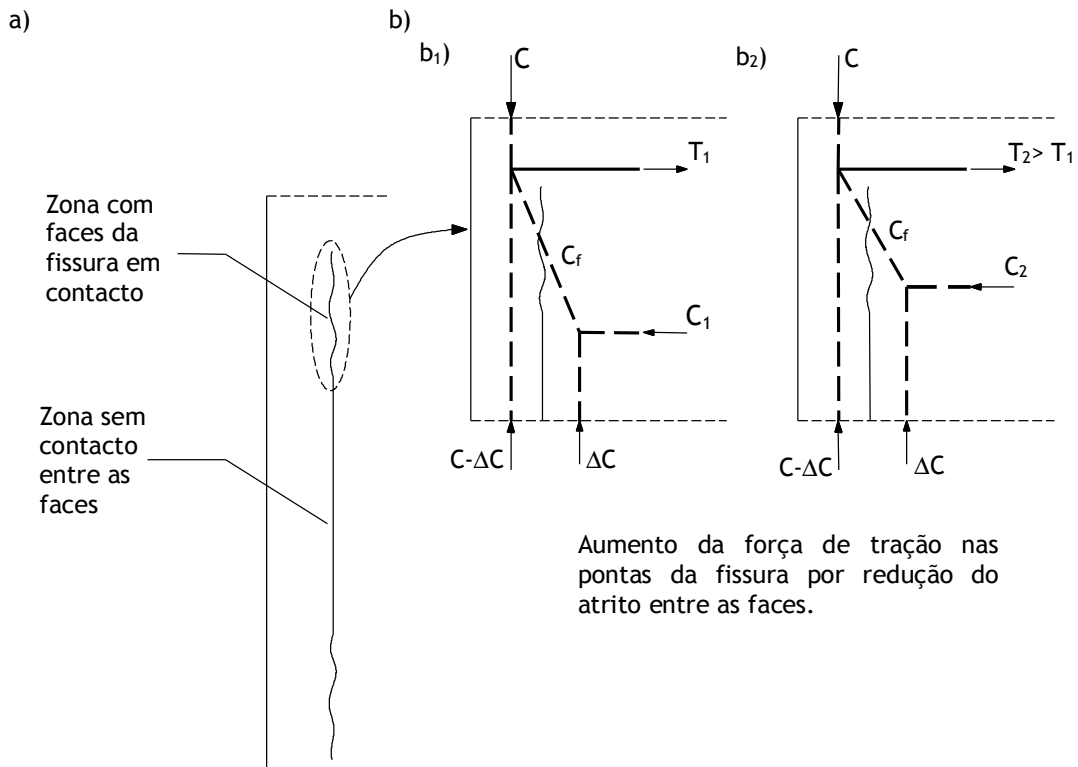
a) Fissura com progressão junto à face; b) Modelos de escoras e tirantes na ponta da fissura, traduzindo a redução do atrito entre as faces.
